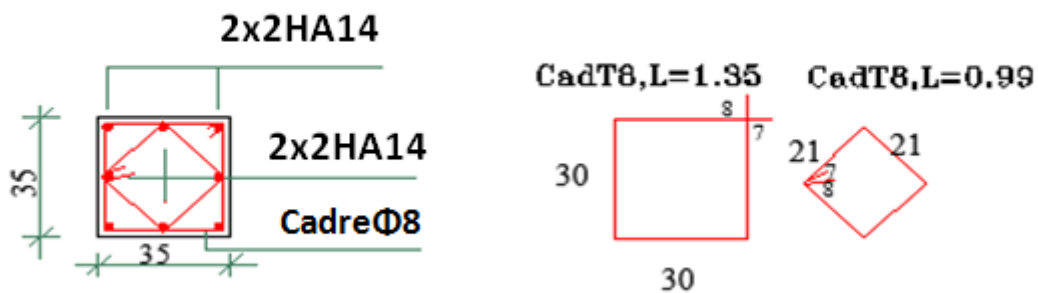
Disposition des armatures dans les poteaux (35x35)
